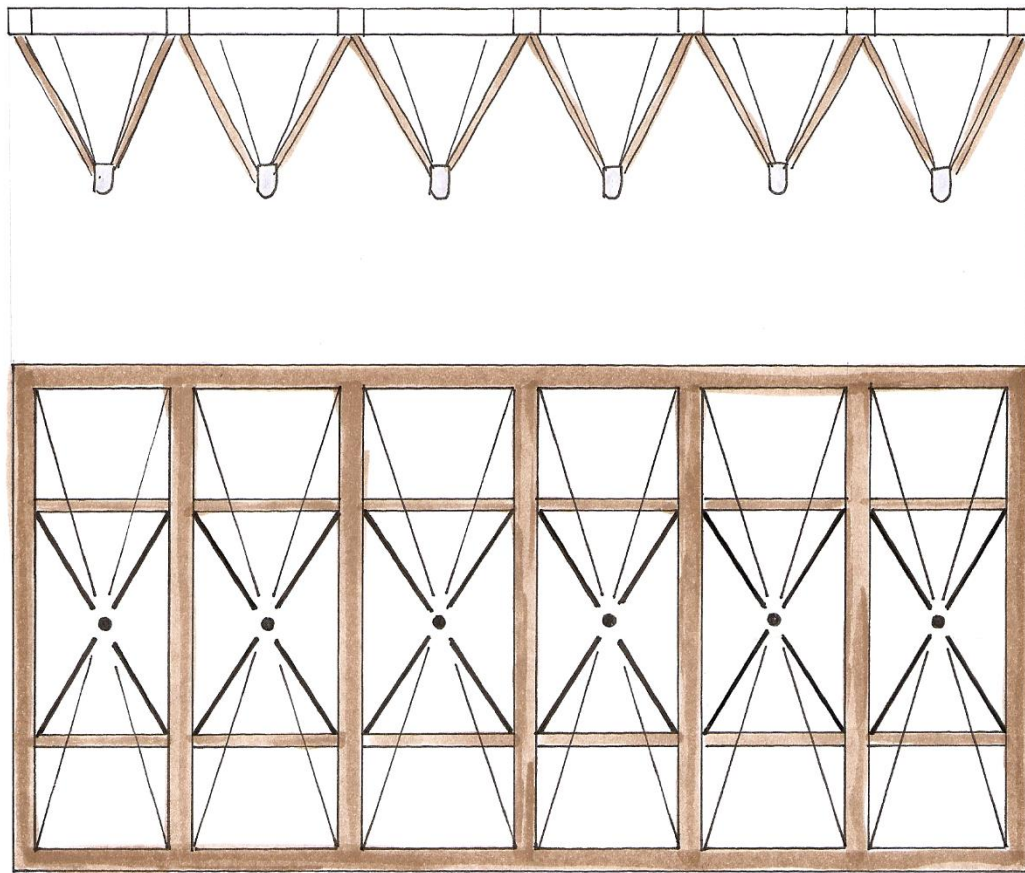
Estrutura da sala de vão livre em planta e em vista. (Sem Escala)
